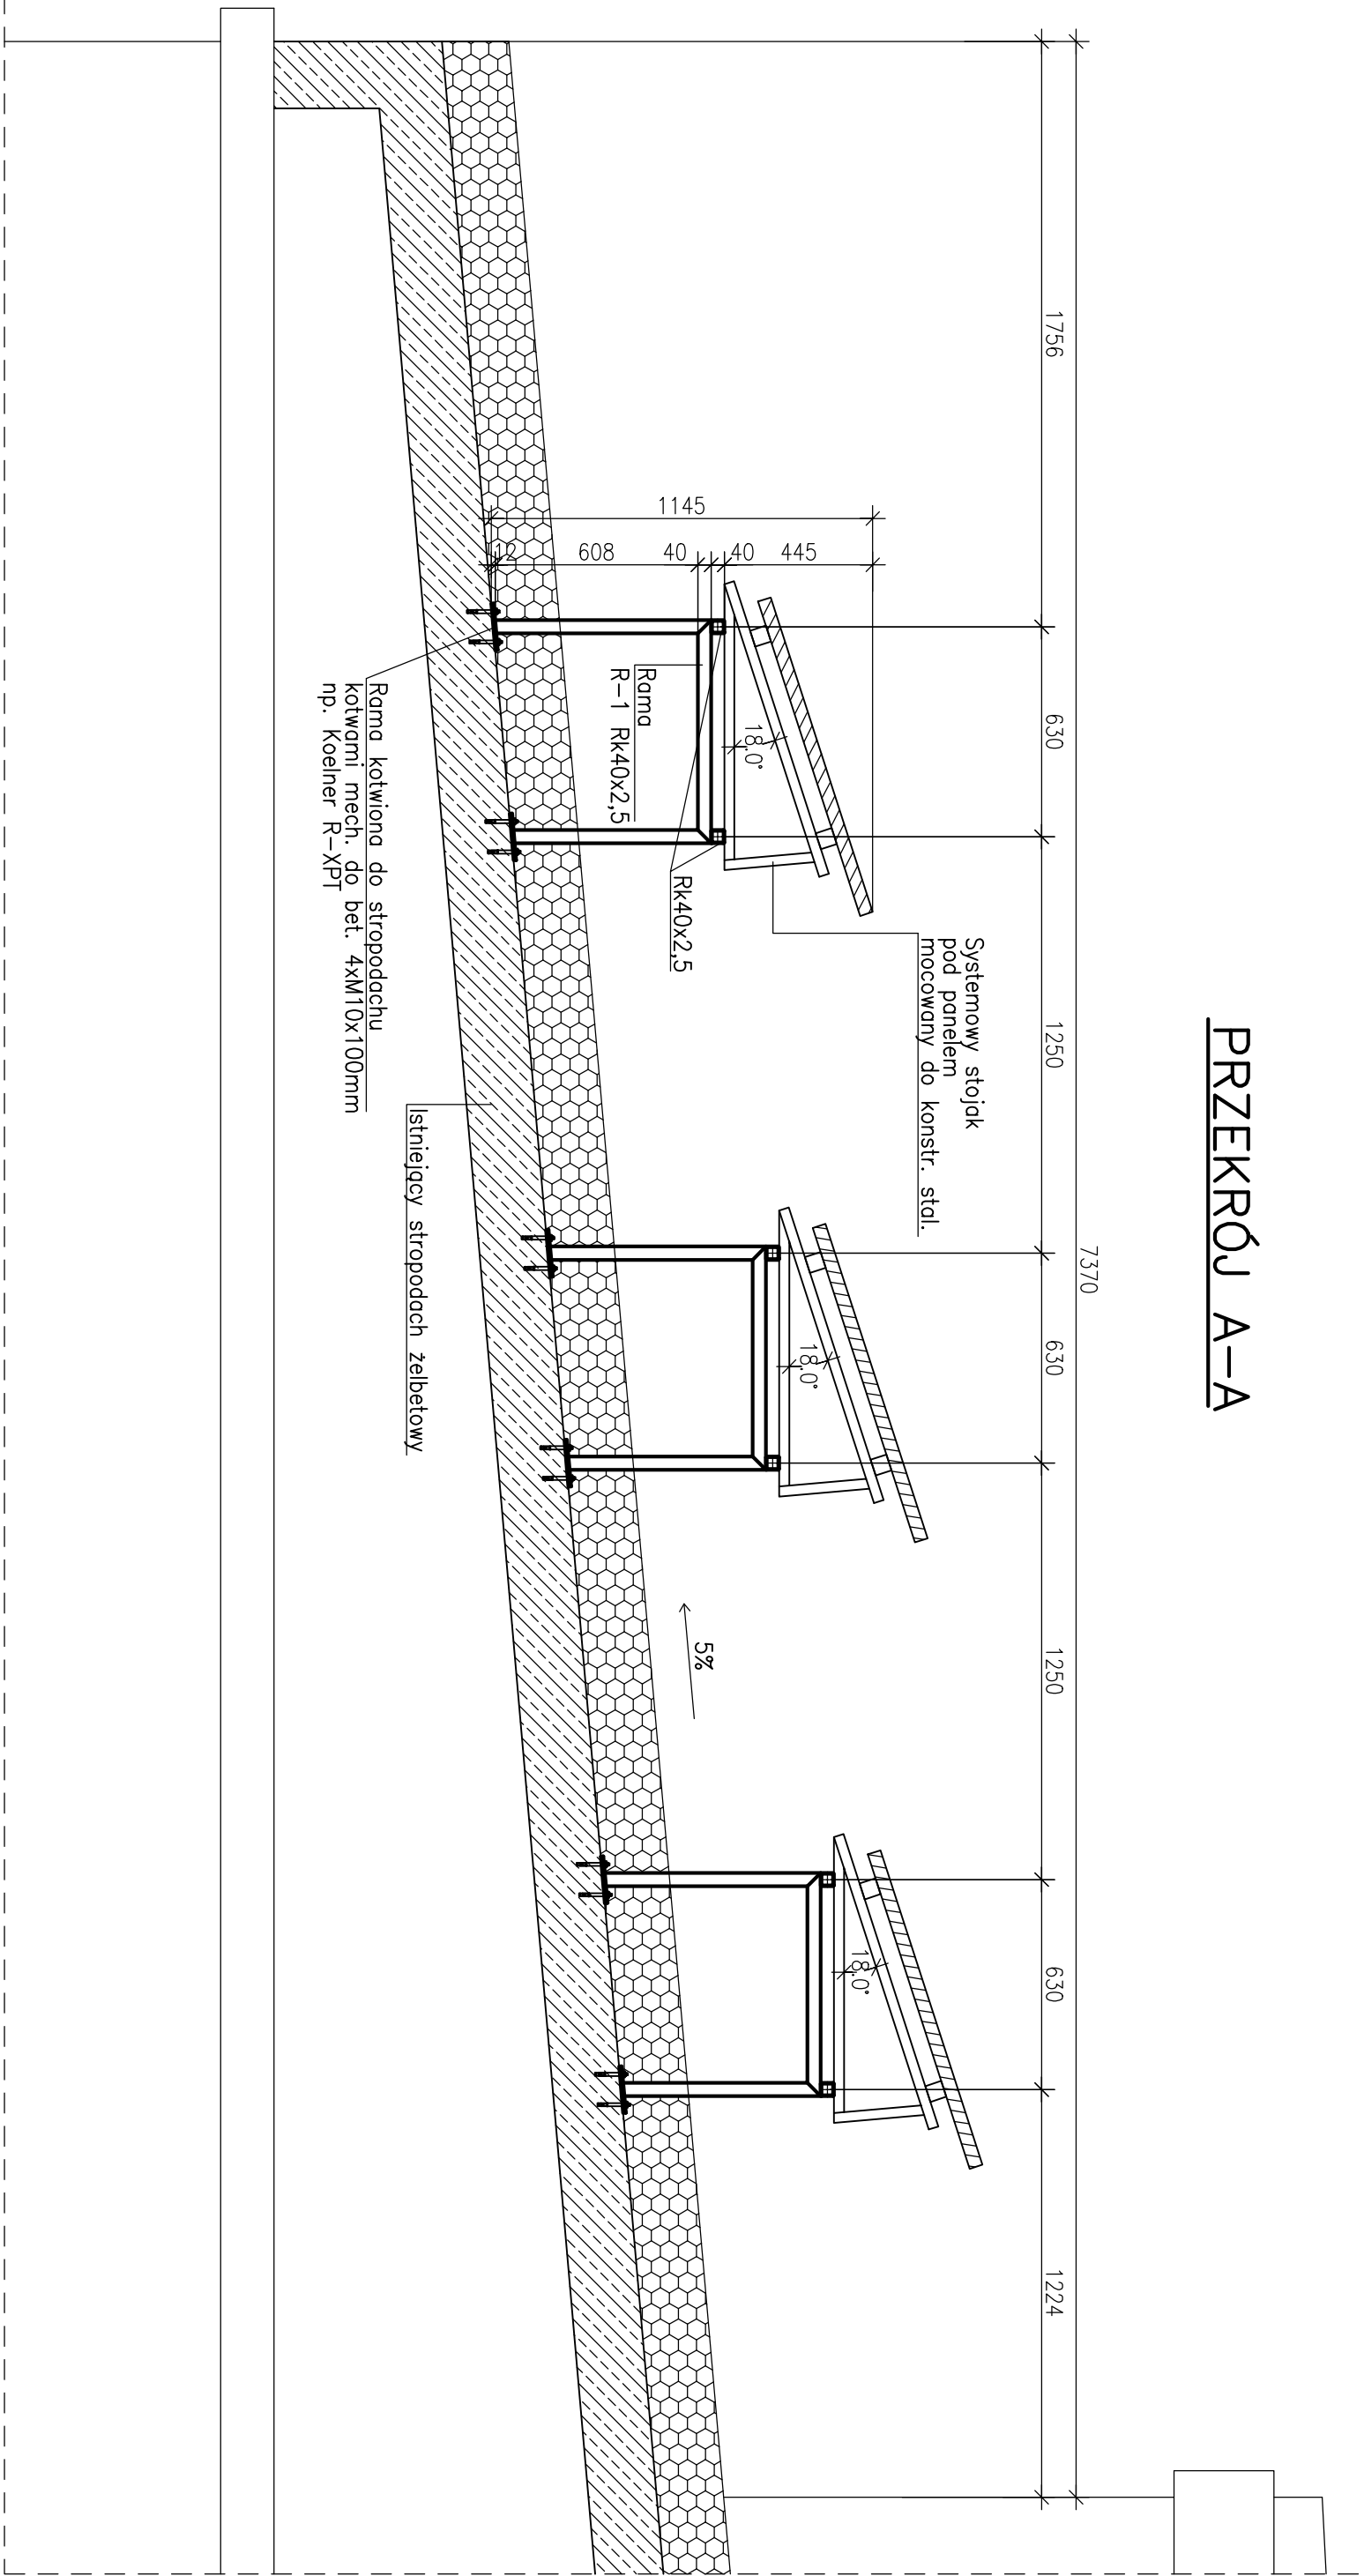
Rozmieszczenie paneli fotowoltaicznych na dachu 1:100
